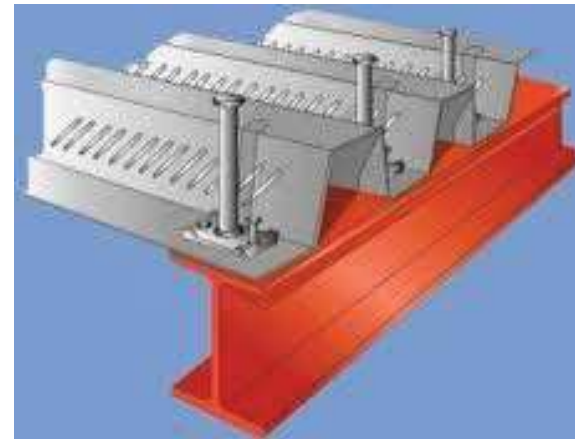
EJEMPLO DE VIGA TIPO "I".
